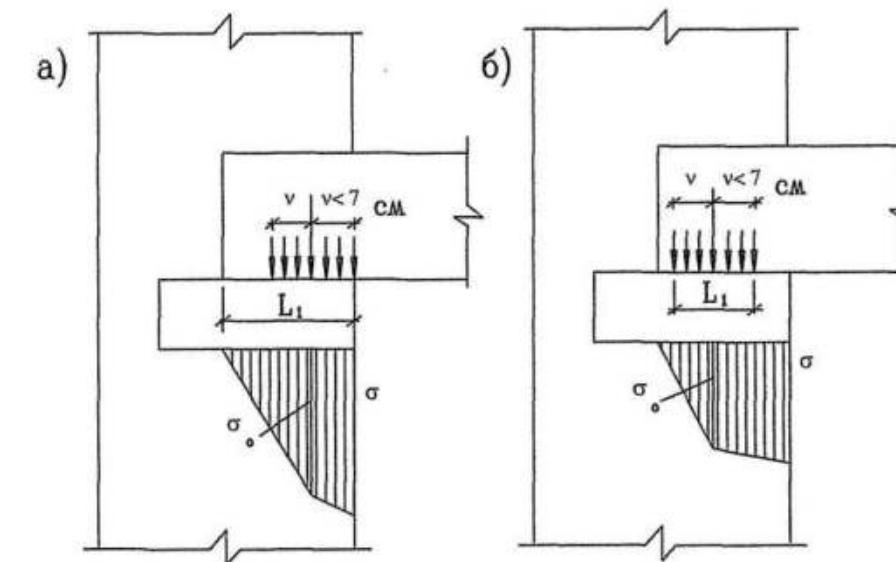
Схема нагрузок и напряжения при расчете опорной плиты
